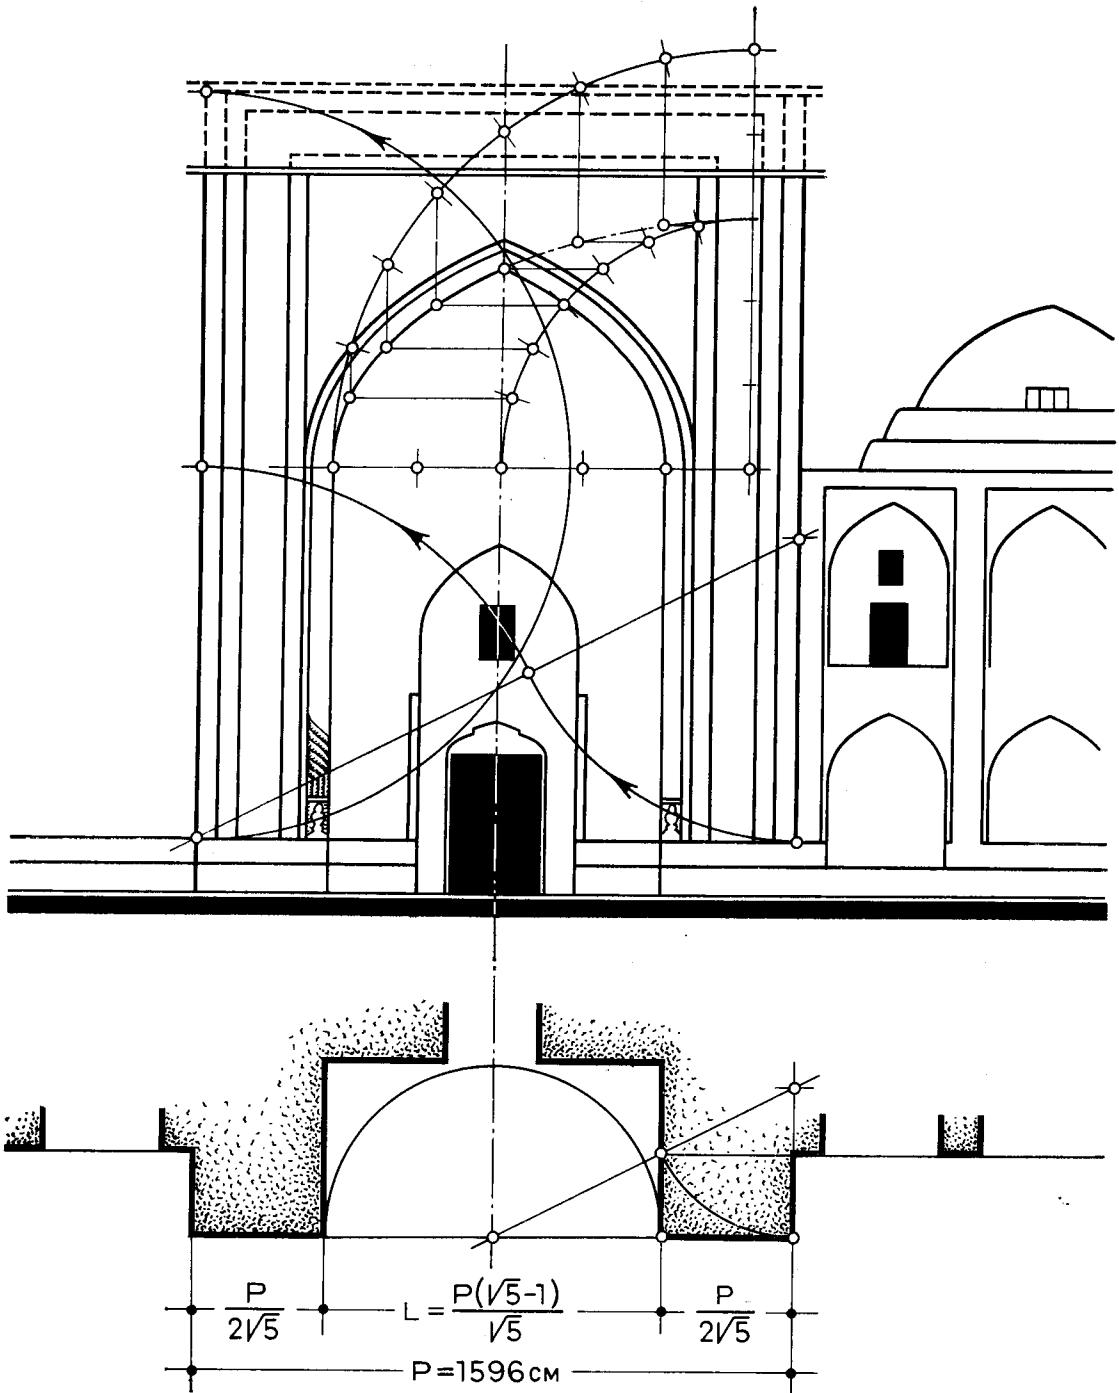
Бухарское медресе Улугбека. Портал. План и фасад.
